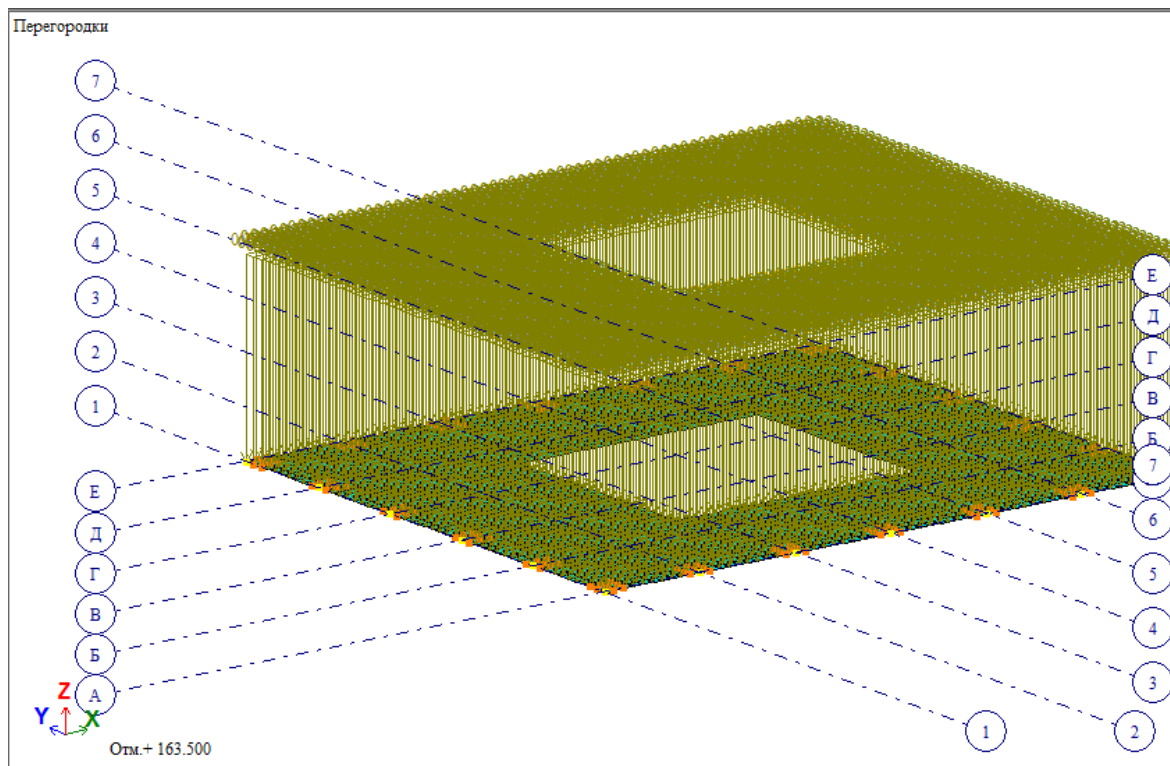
Схема приложения нагрузки от перегородок.
